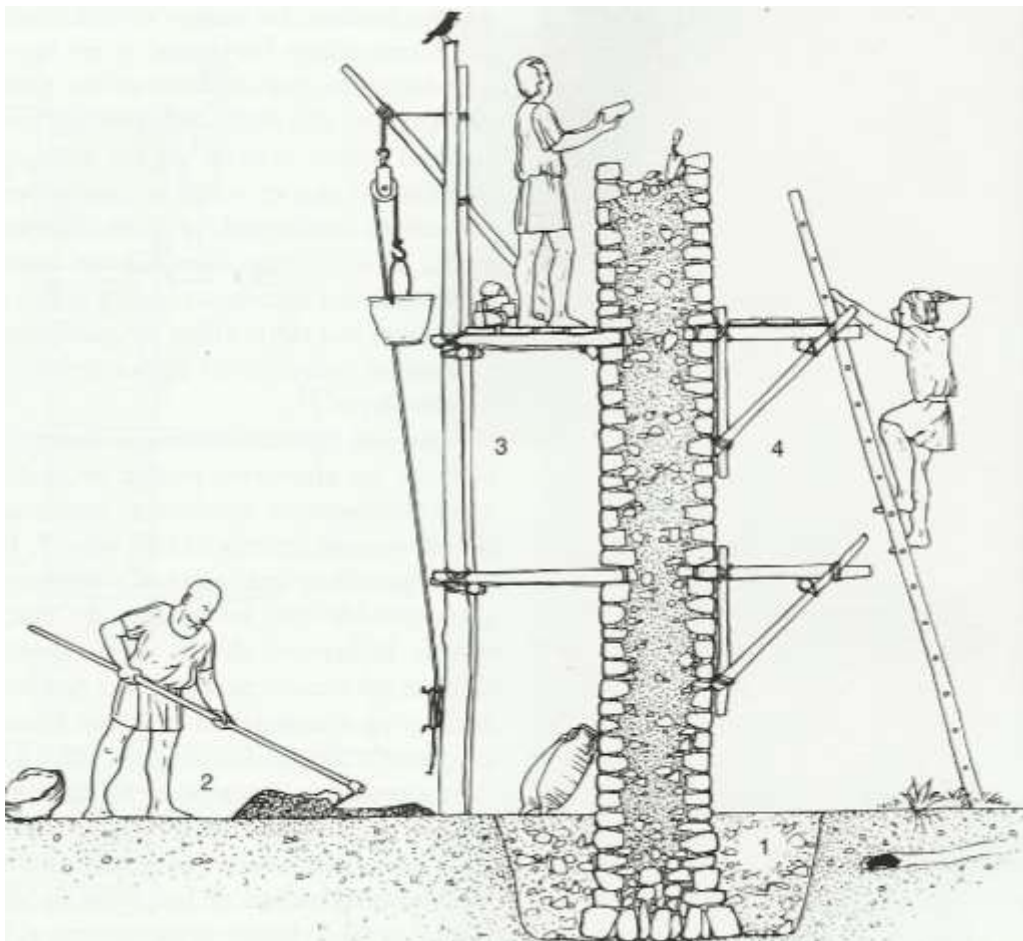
Detalle de la construcción de un muro con andamios de pértiga y almajoyas y de báscula (Imagen.190 en Adam 2002:90)).
